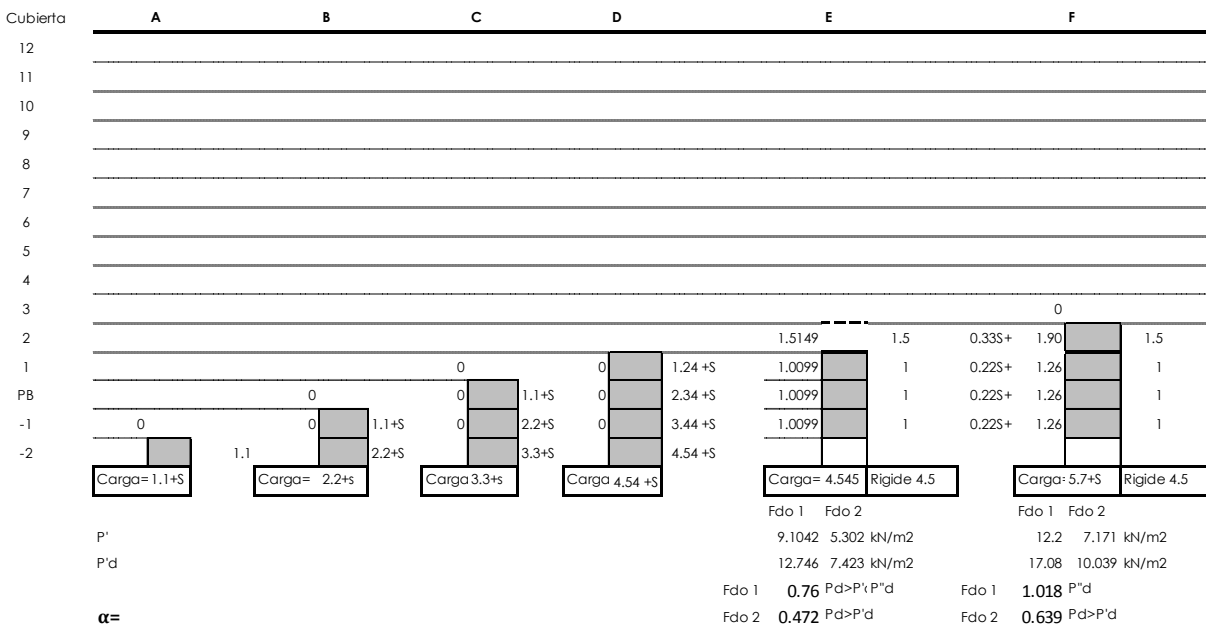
Proceso Constructivo. \$ cimbras 3 forjados de sacrificio. Losa Maciza. 1/5
